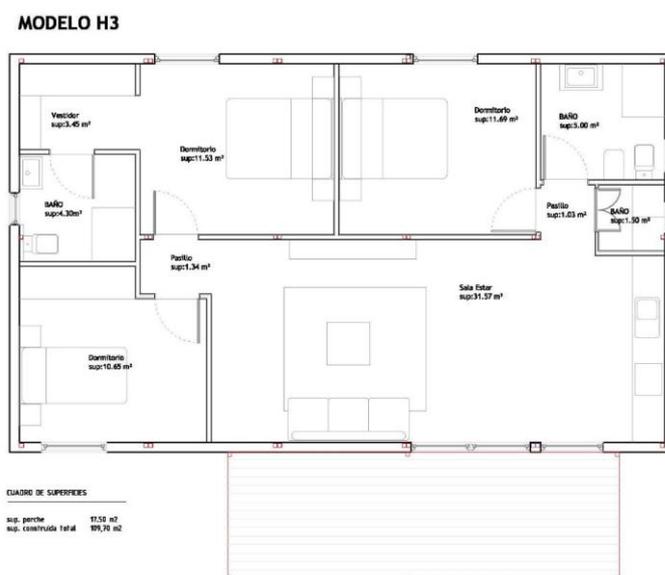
Plano vivienda modular 3 dormitorios, Empresa HOME3
